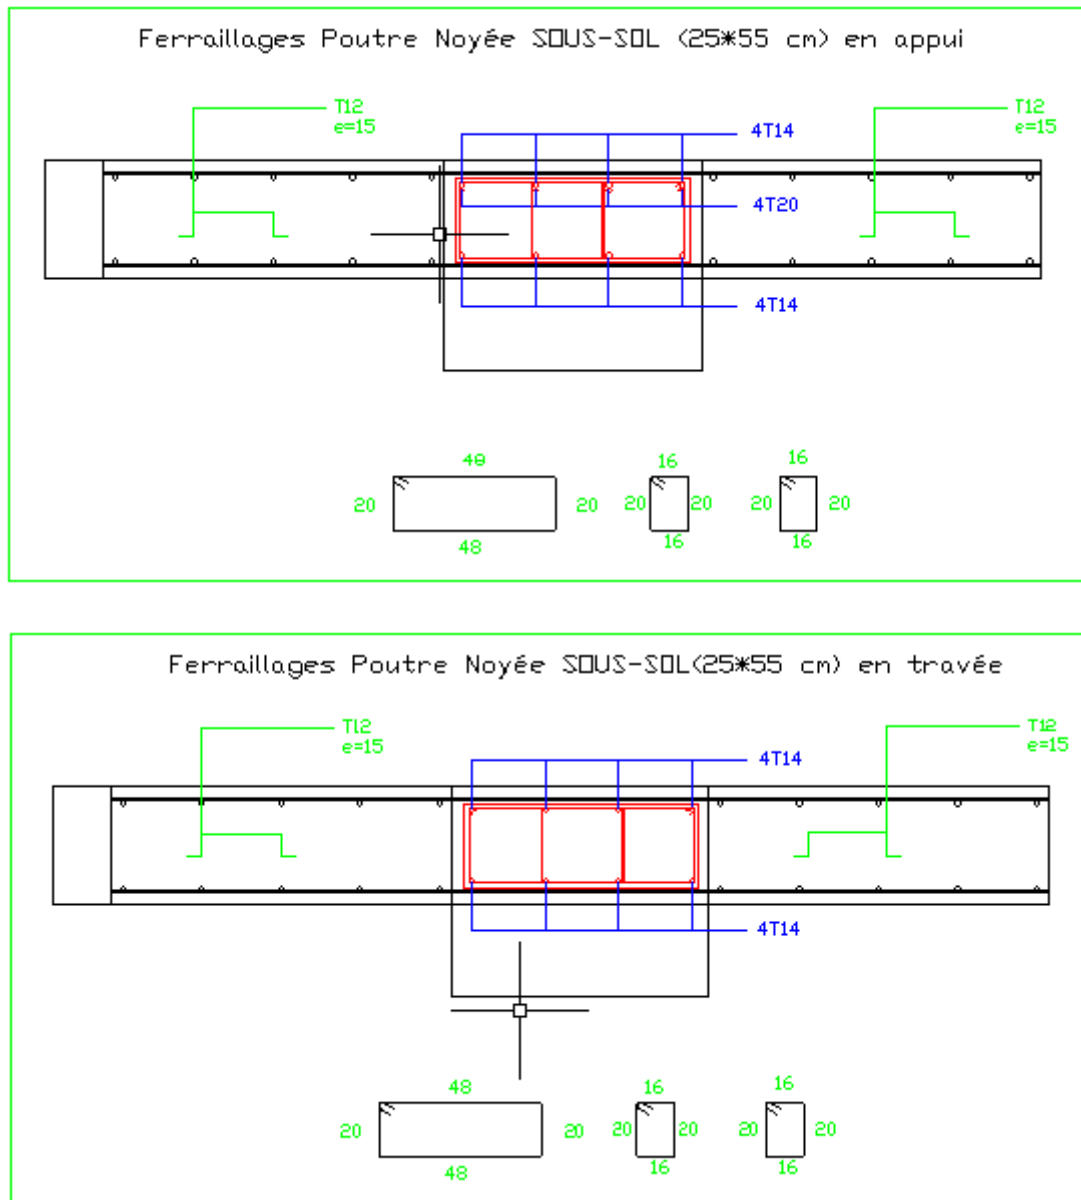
Ferraillage poutre noyé (25*55) appui et travée sous-sol
